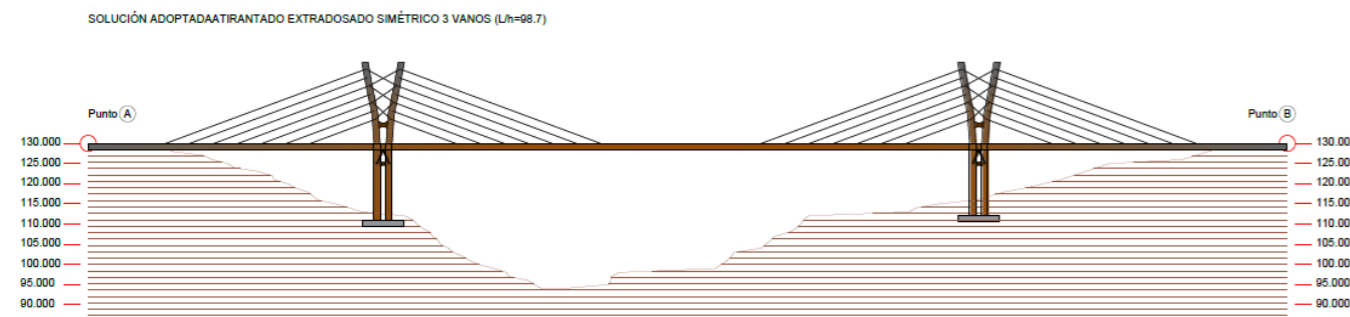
Alzado de pasarela atirantada (solución adoptada). Fuente: Elaboración Propia (AutoCAD)
